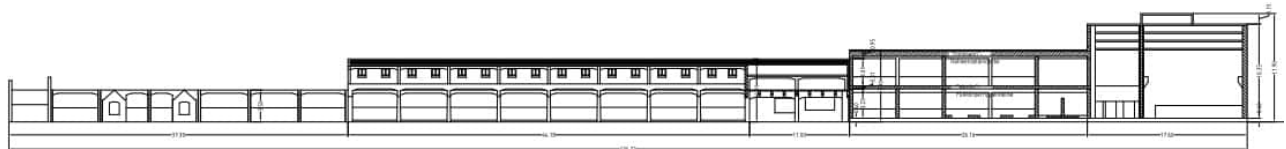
Übersichtsplan Kesselhaus (Gesamtgebäude)
